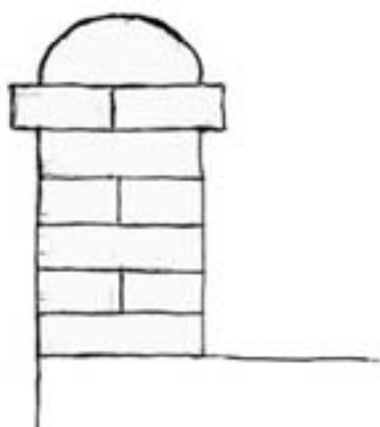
Detalle del muro barandal. Dibujo: G. Boils.
